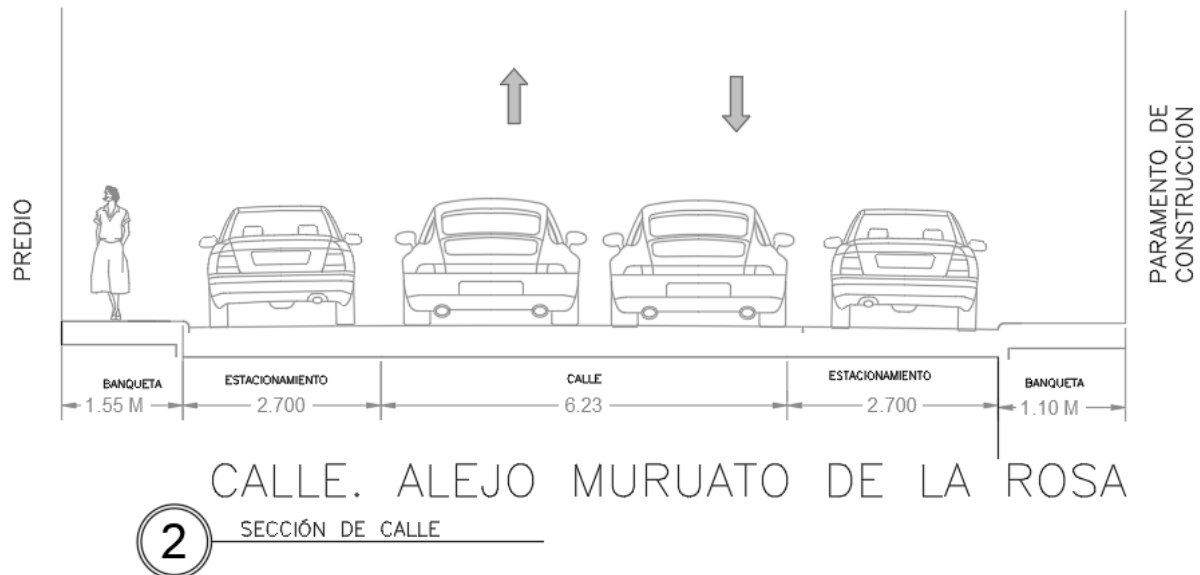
Sección vial propuesta para calle Alejo Muruato de la Rosa
